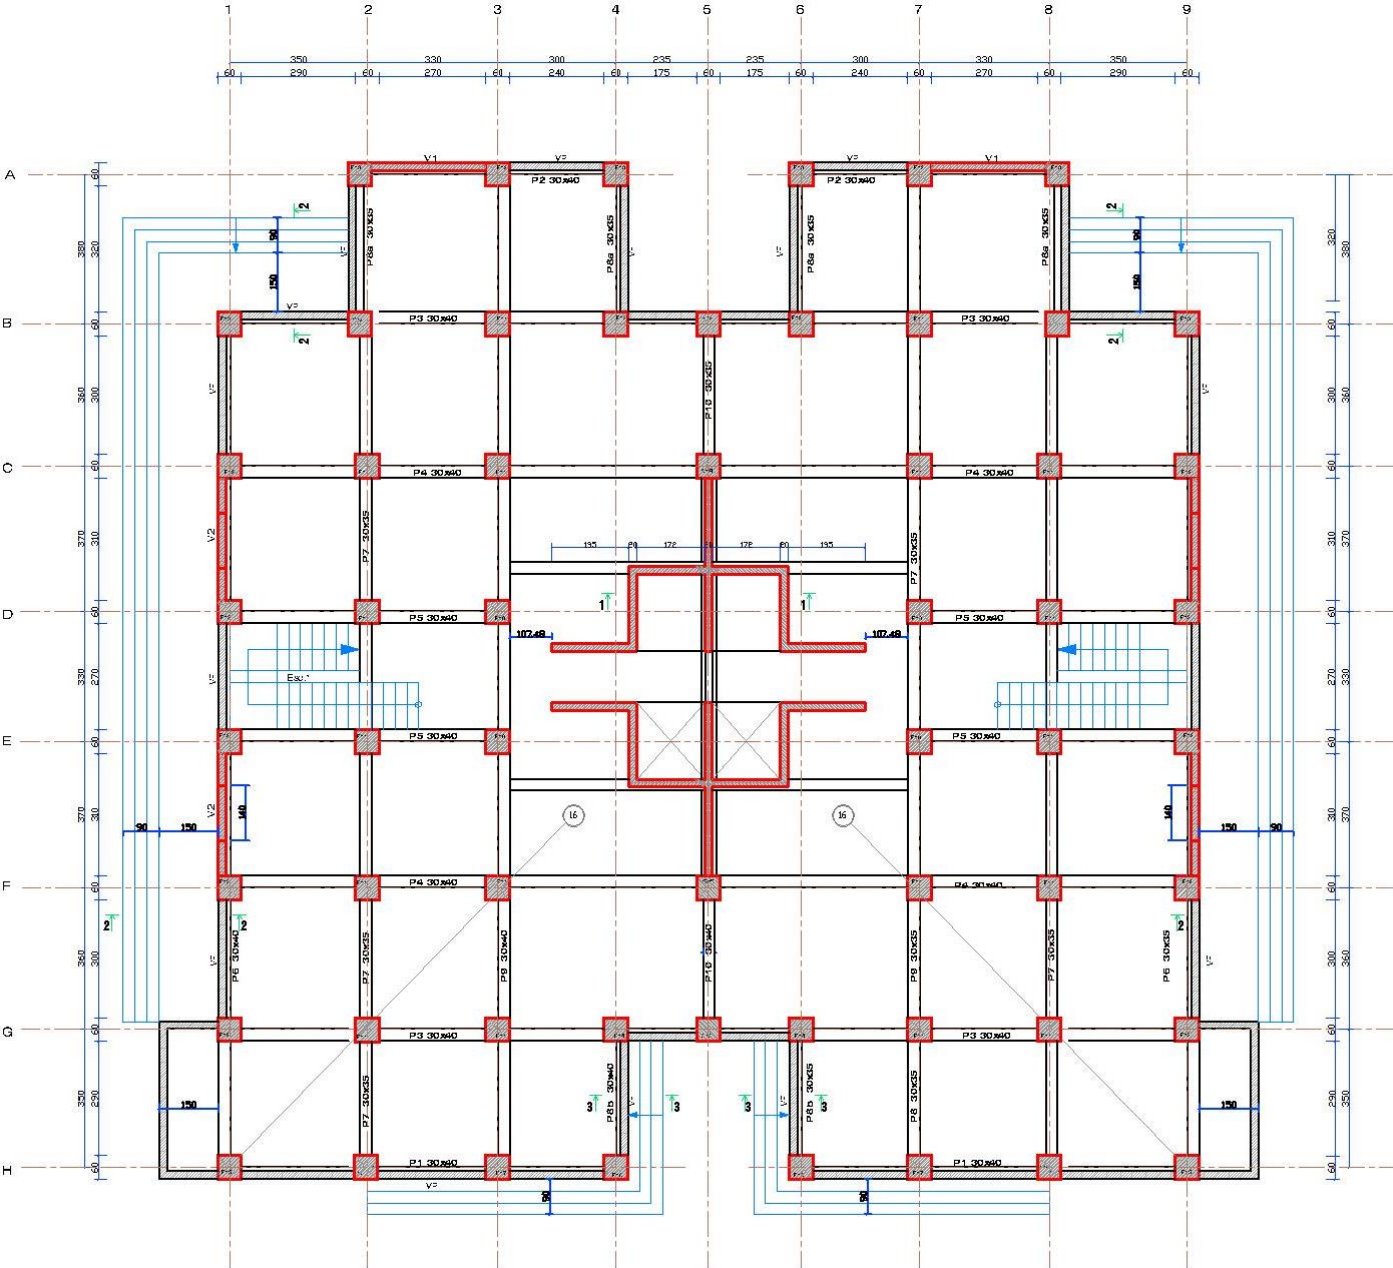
Plan de coffrage de niveau -3,00 (Plancher à dalle pleine).
